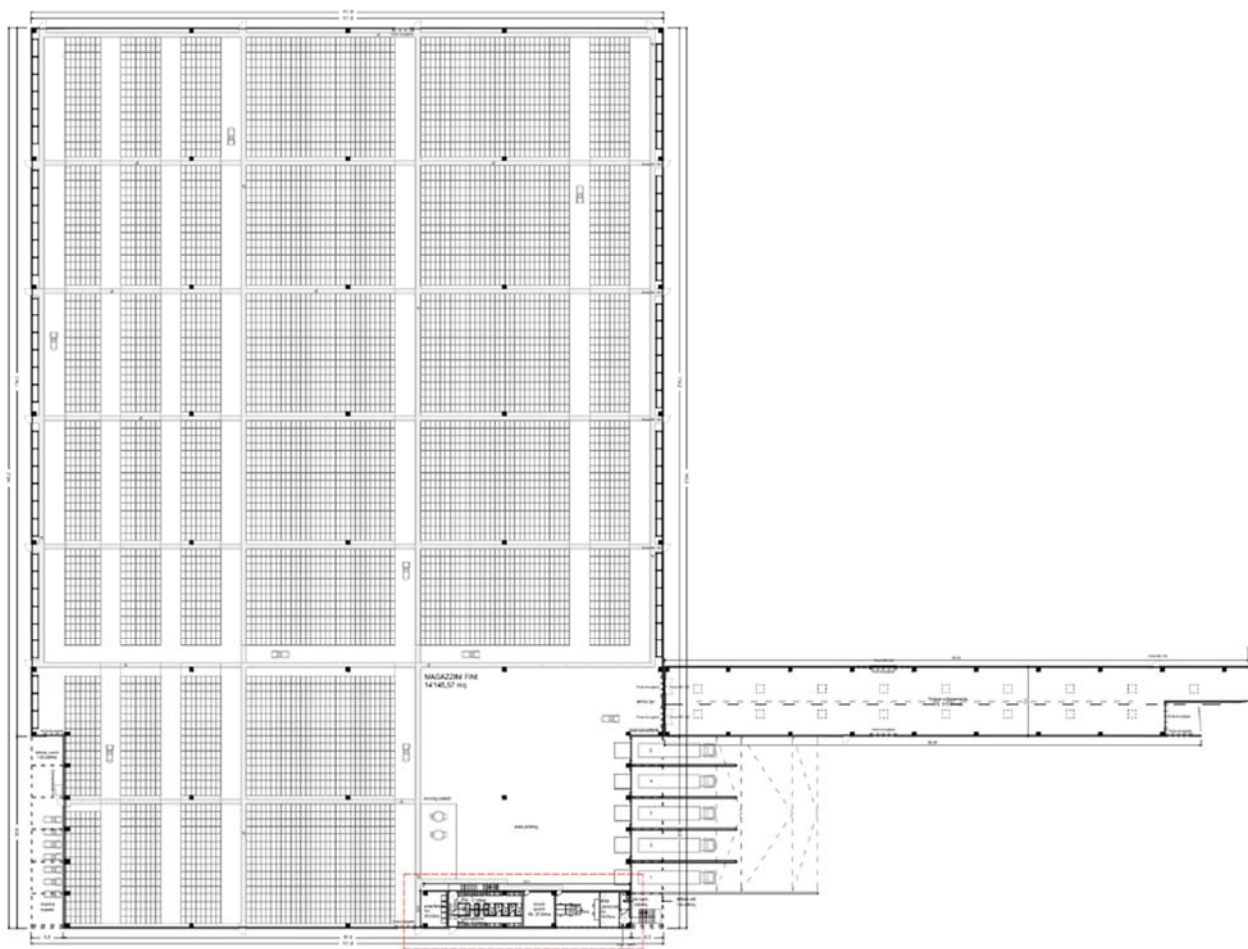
Planimetria interna del nuovo corpo di fabbrica
